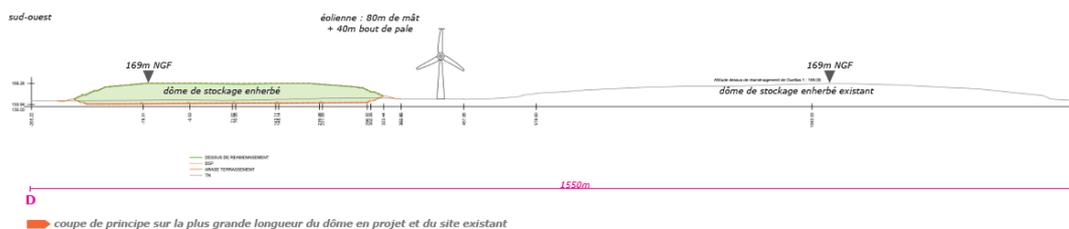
Coupe de principe sur la plus grande longueur du dôme en projet et du site existant
